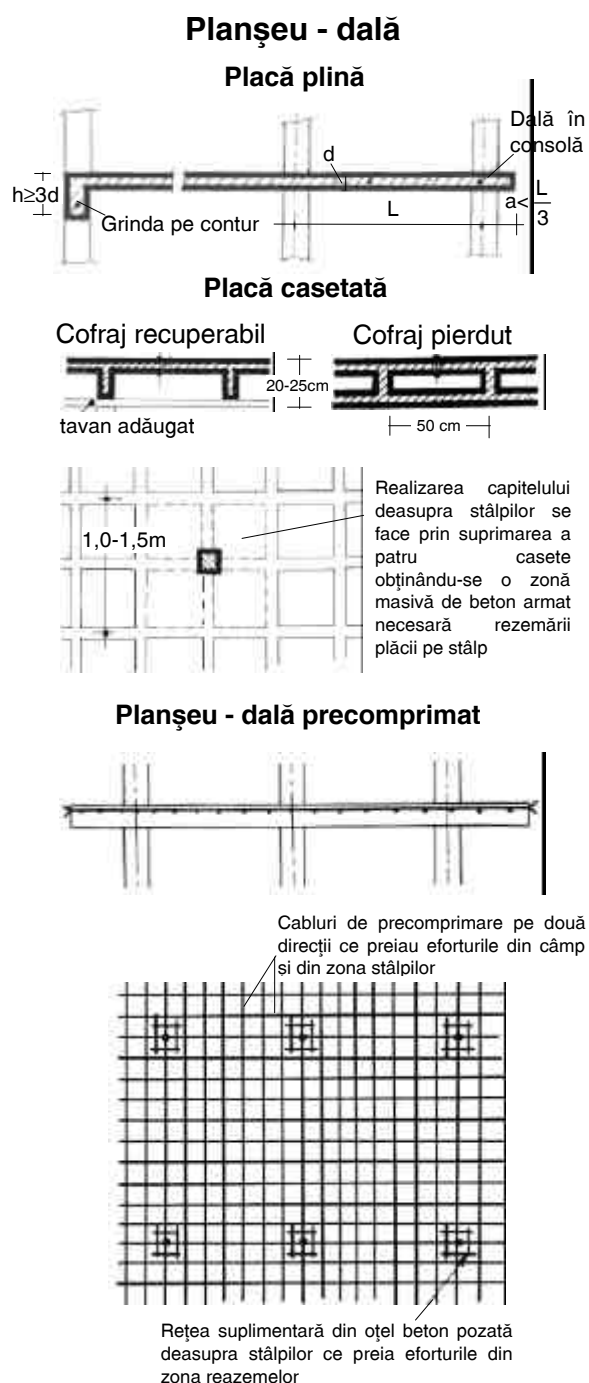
Planșeu - dală din beton armat monolit. Placă plină. Placă casetată. Planșeu-dală precomprimat
